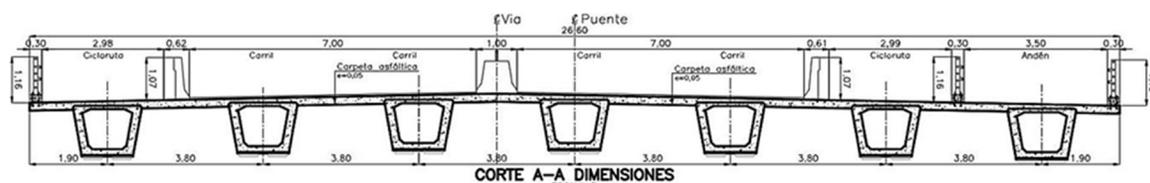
Sección transversal puente proyectado en intersección Av. Ciudad de Cali con Av. Calle 72
